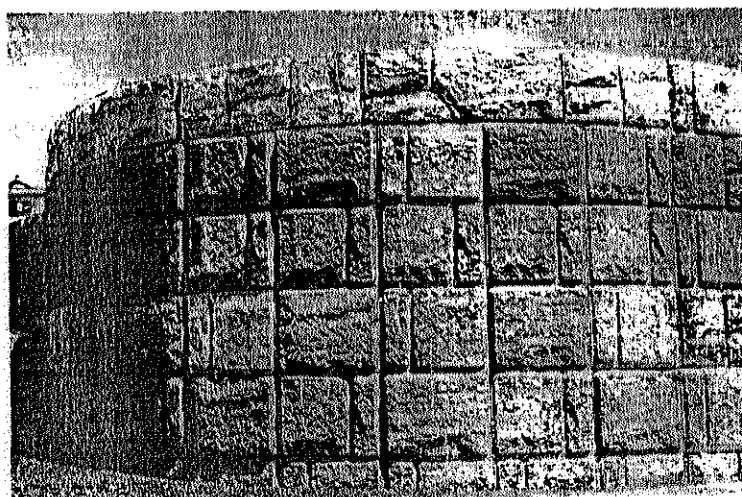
タイプ3の施工例：静岡県県営（三島徳倉）団地造成工事
